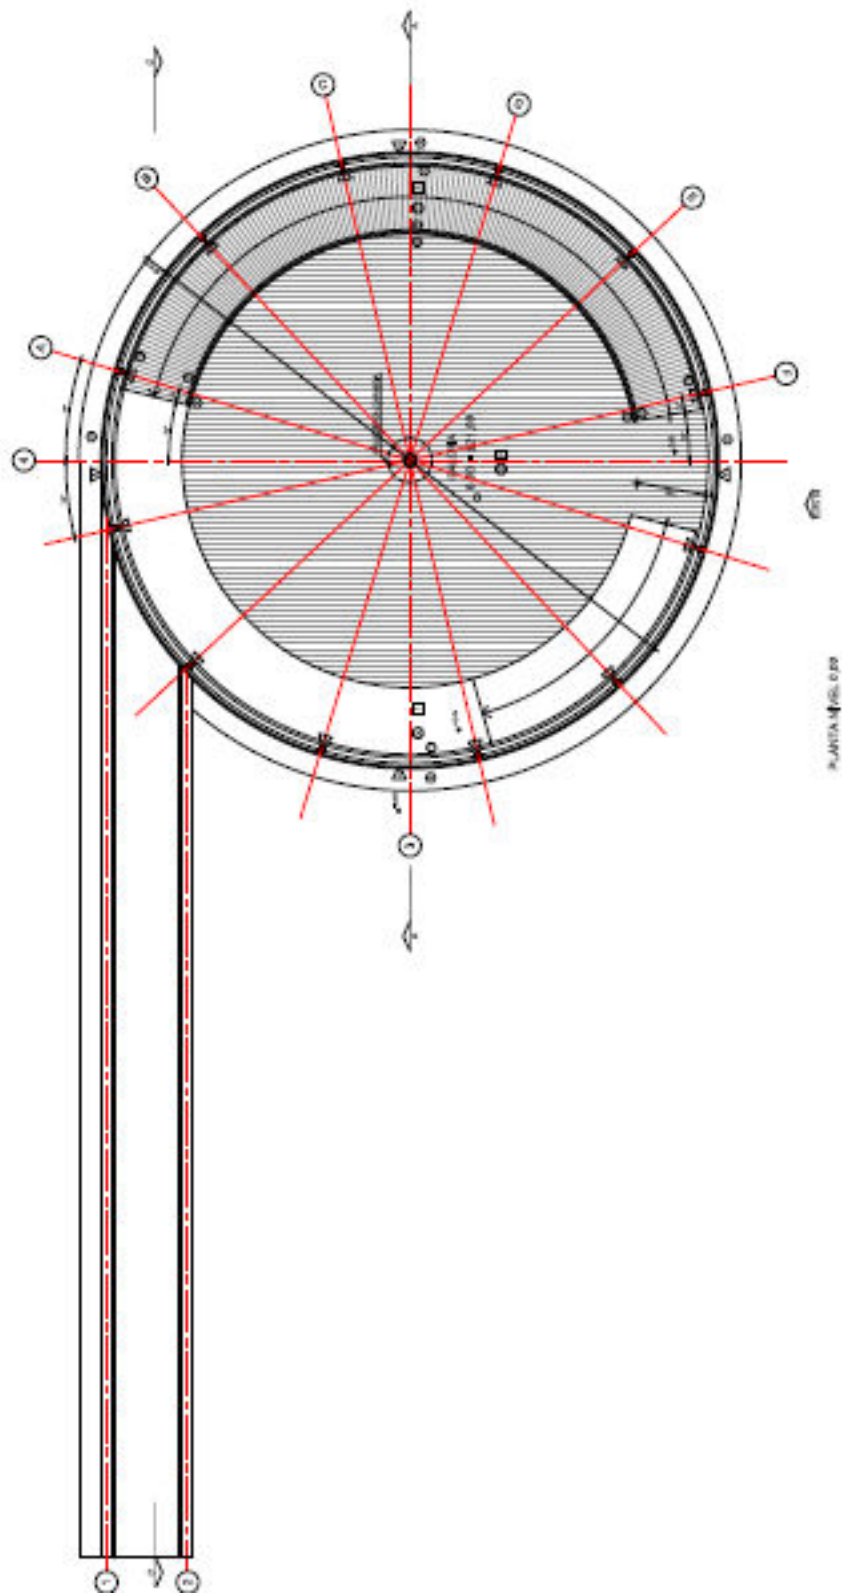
Planta baixa SonicPavilion, Paula Zasnicoff. (TONETTI, 2013)
